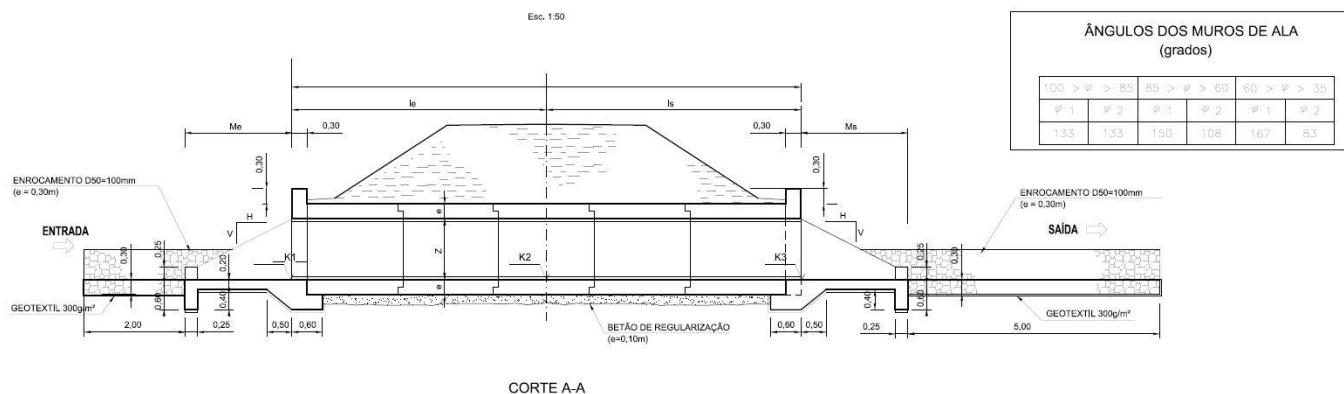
Rede Adutora Principal. Corte de passagem hidráulica.
